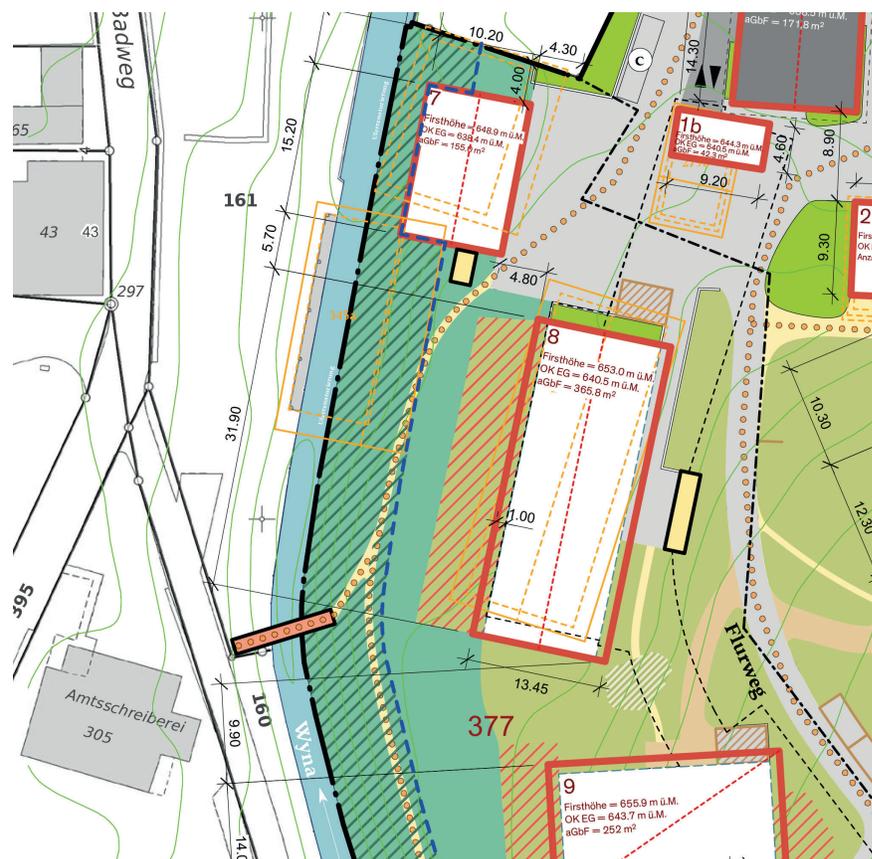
Ausschnitt aus dem Gestaltungsplan Hinder Müli (Stand Nov. 2018): Geplanter Rück- und Ersatzbau des nördlichen Gebäudes. Der Gewässerraum wird entlang des neuen Baufelds geführt.
